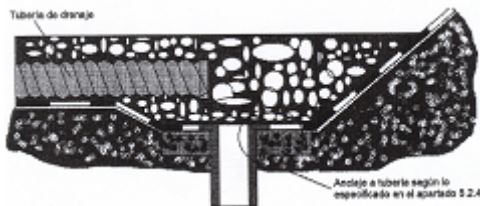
Extracción del lixiviado con tubería de fondo. Solución recomendable.
